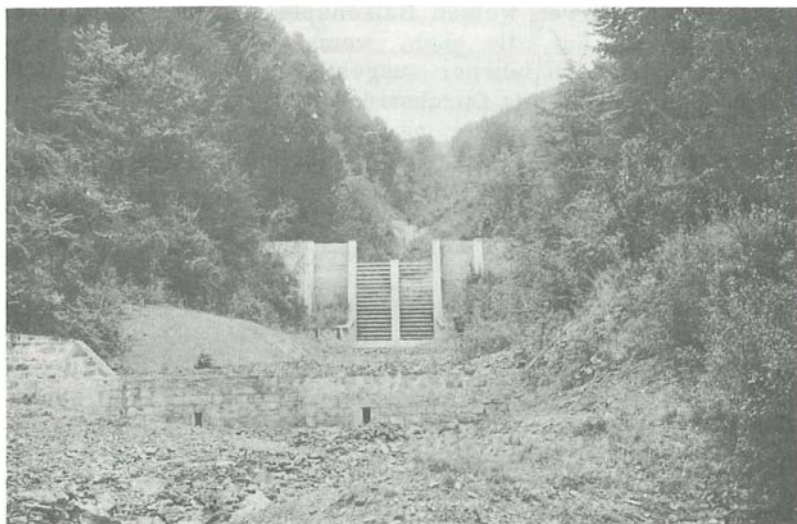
Pfeilerreihensperre mit vorgefertigten Stahlbetonbalken im Wildbach Cernica, Rumänien.
